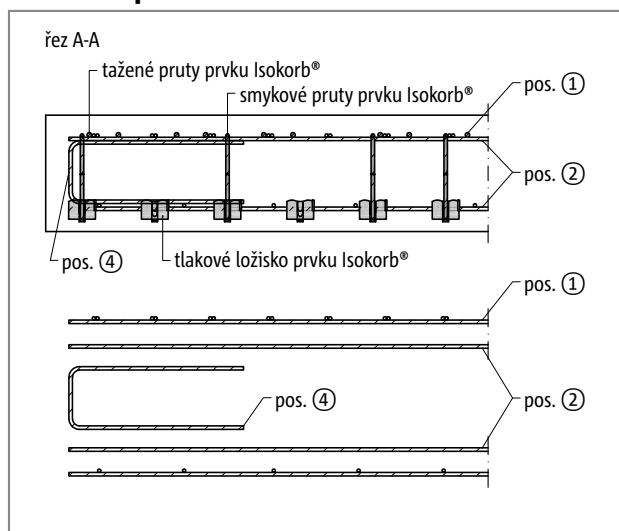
Schöck Isokorb® XT typ KL: Napojovací stavební výztuž u přímého uložení
